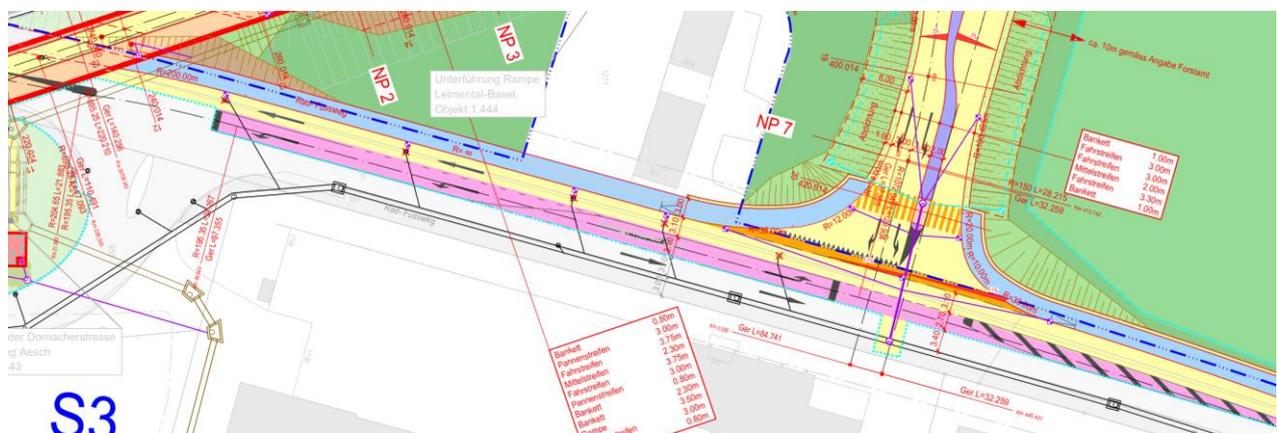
Einmündungsbereich Dornacherstrasse mit Langsamverkehrsführung.
